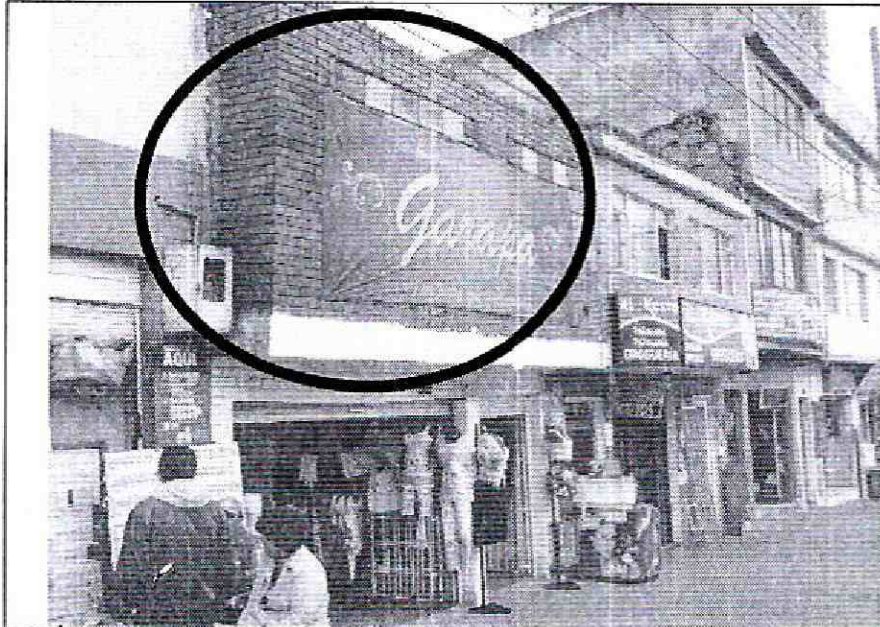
Fachada principal inmueble. Se indica tramo de muro de fachada segundo piso (sector patio)
